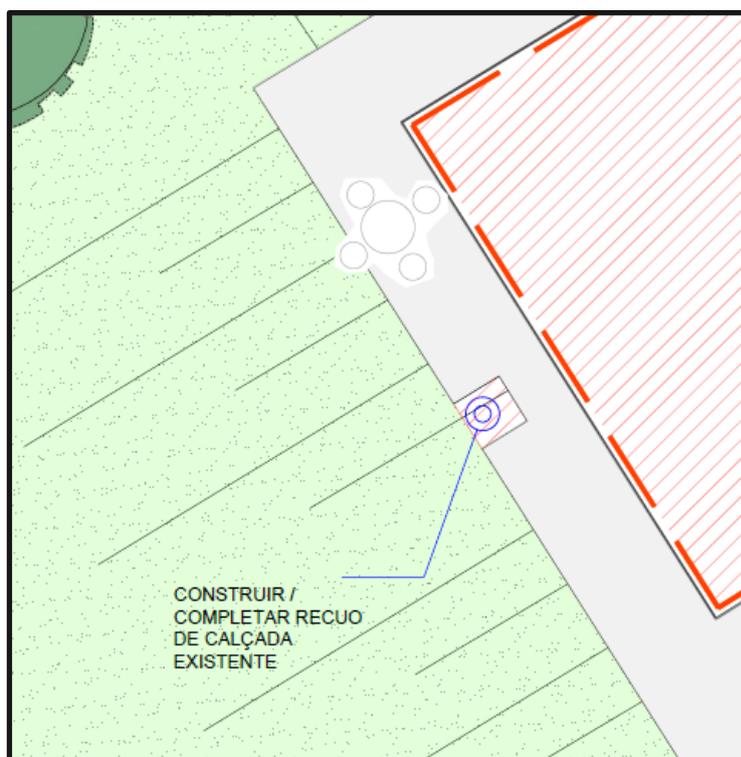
DETALHE DO PISO A SER COMPLETADO – PLANTA DE CONSTRUIR E DEMOLIR
